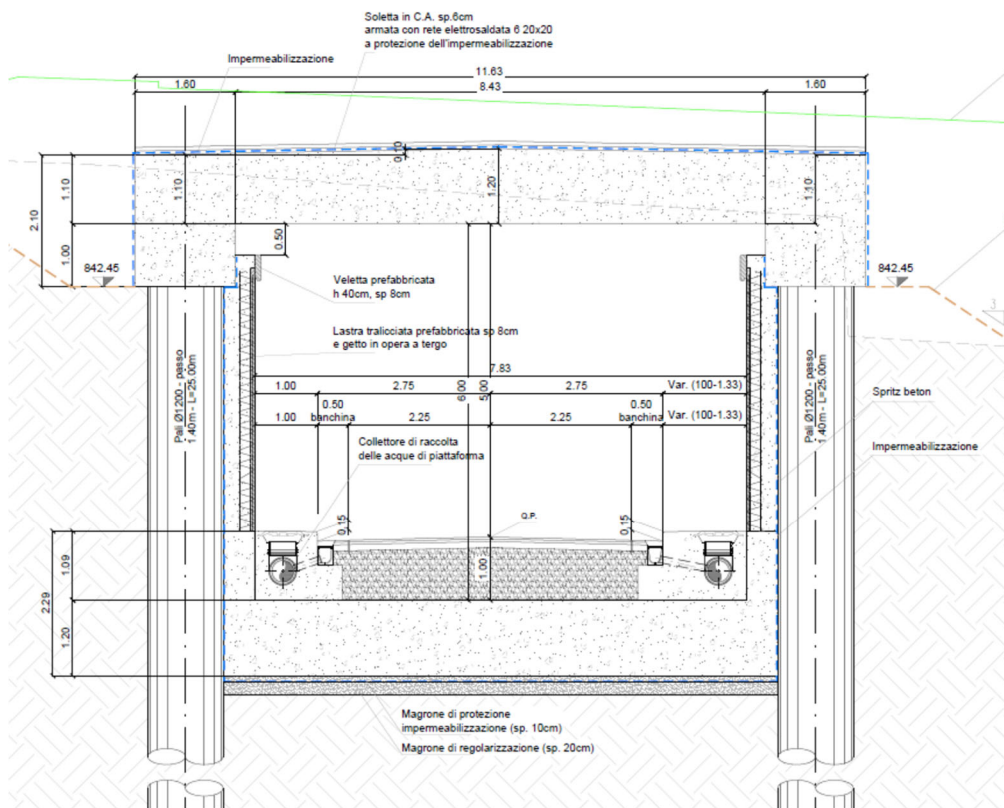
Planimetria e sezione trasversale del sottovia ST003
